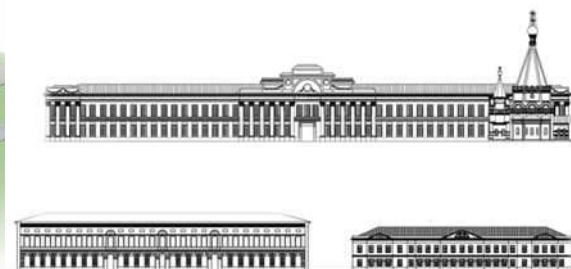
Развертки: вид с площади на здание присутственных мест и поперек площади по проекту арх. Ананьина
